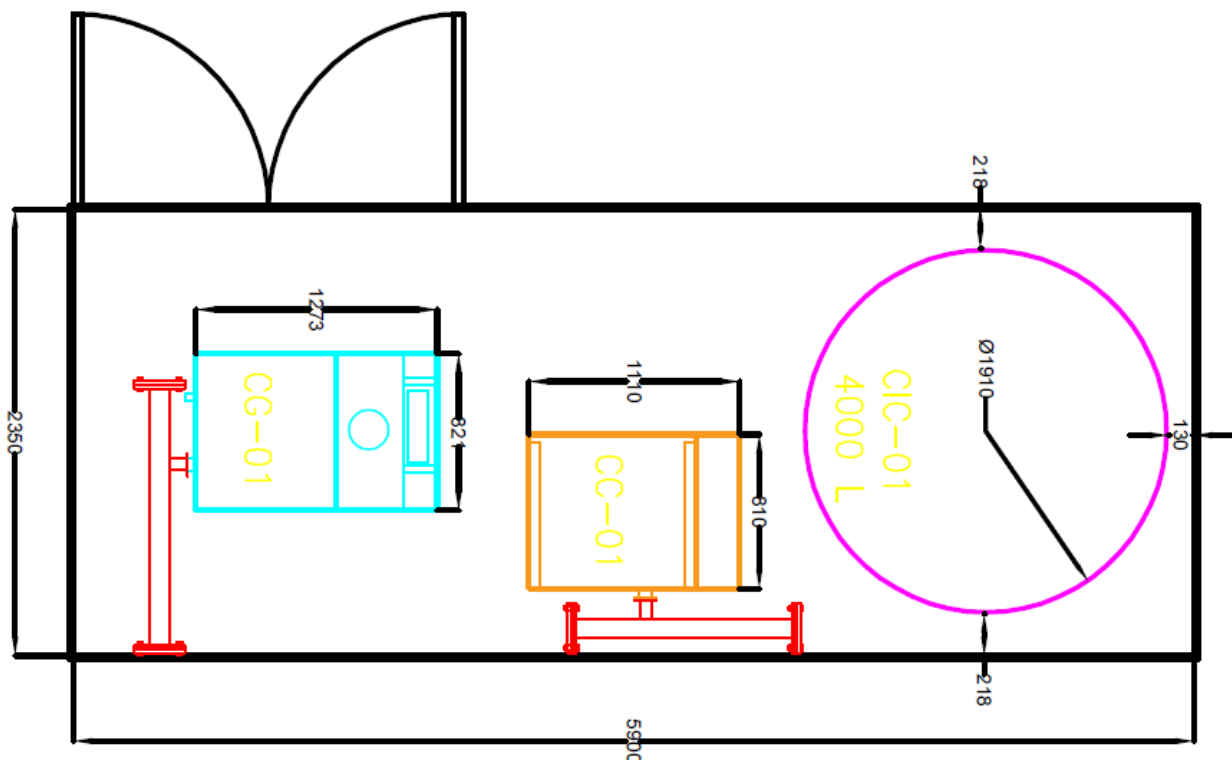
Layout de la sala de calderas de un proyecto residencial tipo
